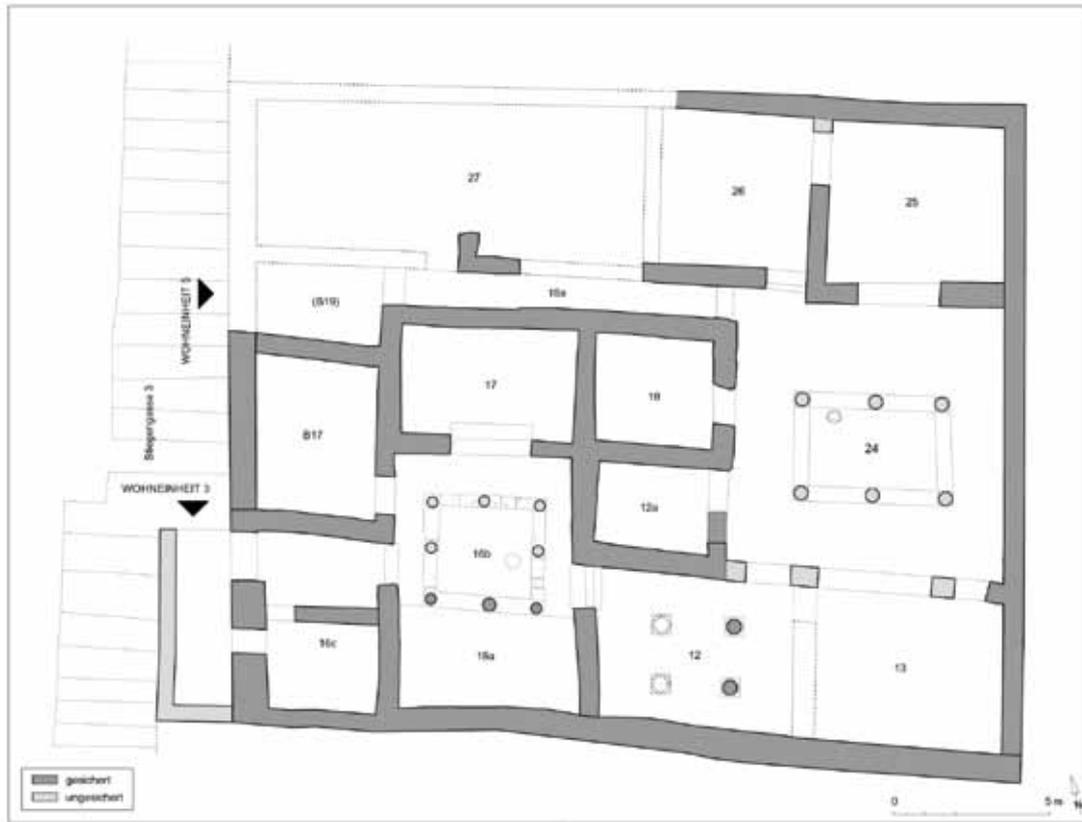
Hanghaus 2, WE 3 und 5, Rekonstruierter Grundriss Bauphase I
